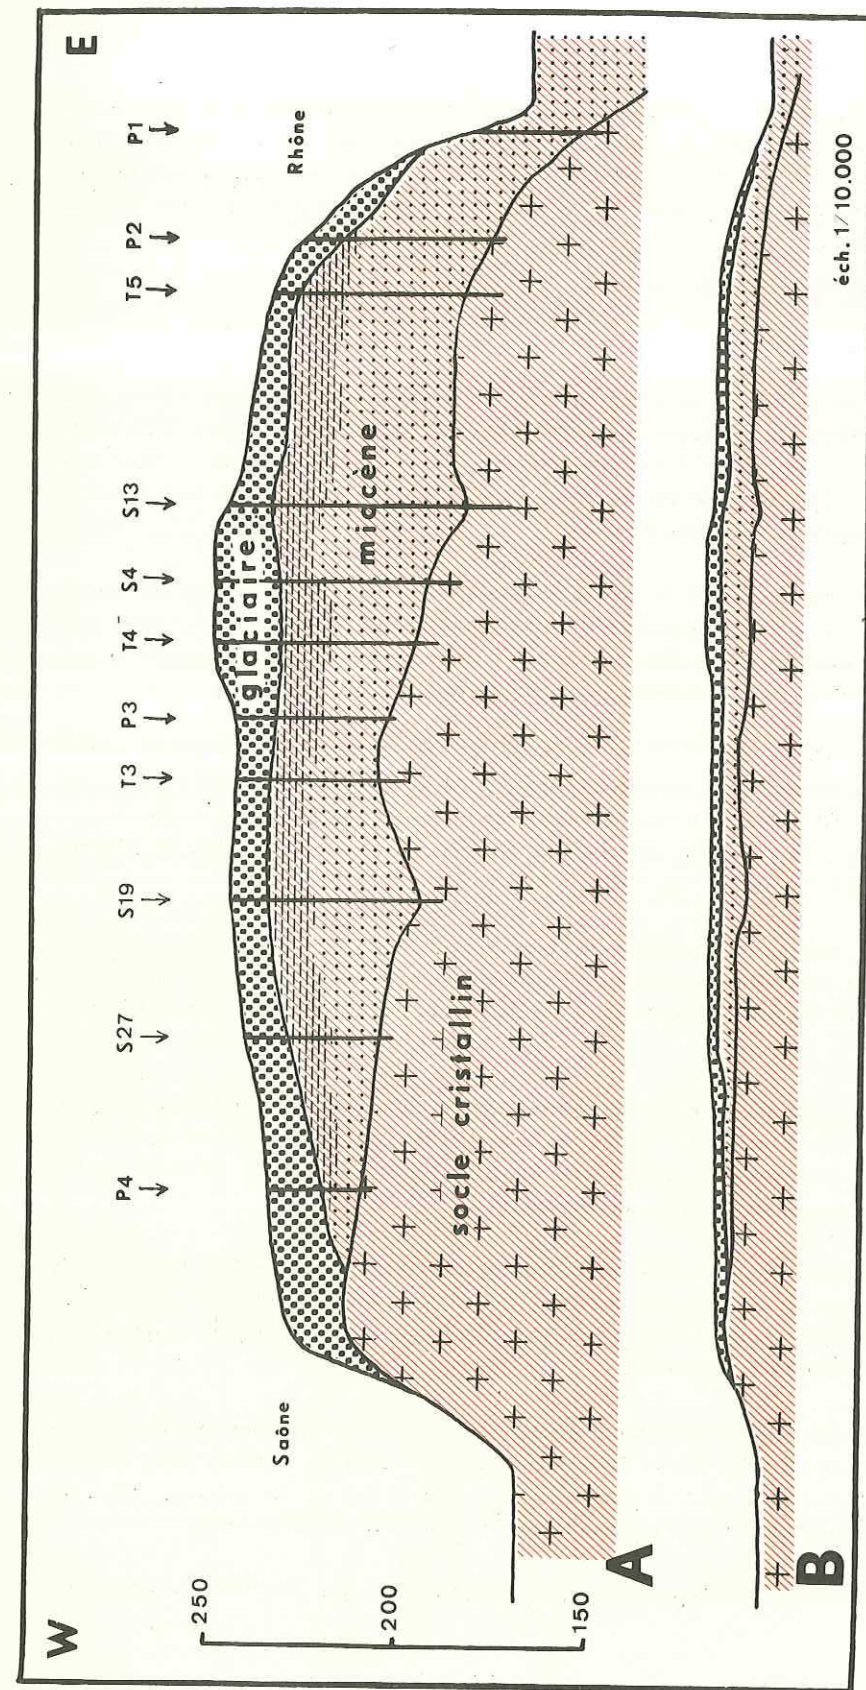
COUPE TRANSVERSALE DU PROMONTOIRE DE LA CROIX-ROUSSE SELON L'AXE DU TUNNEL ROUTIER.
